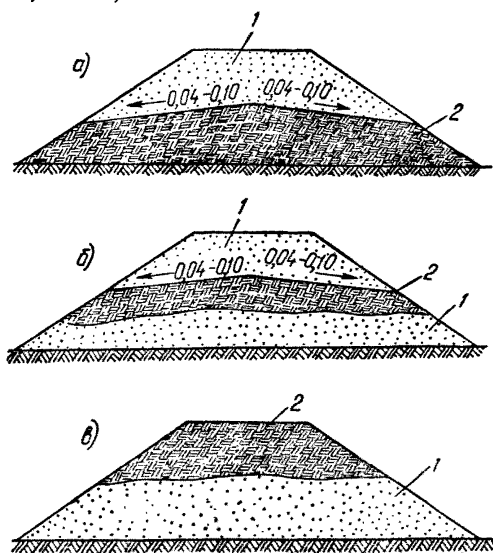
Схемы допустимого расположения грунтов в теле насыпи
